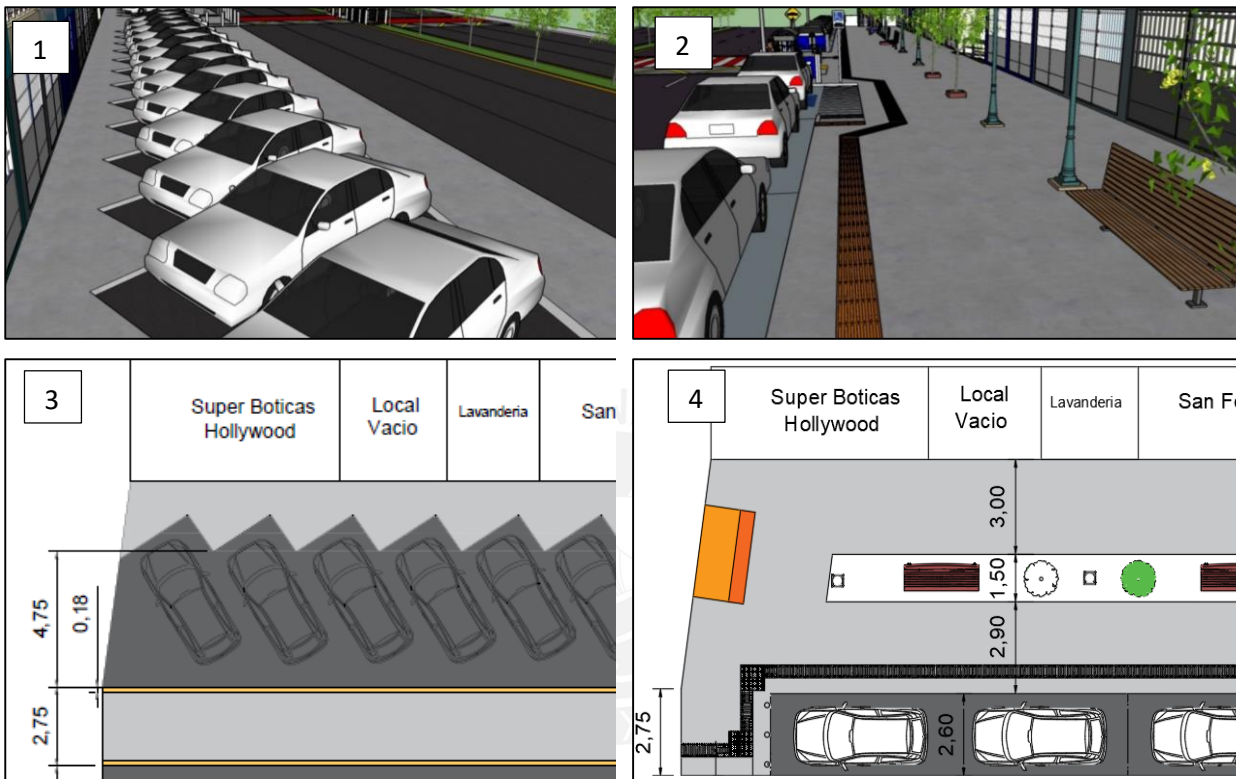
9 - Veredas : 1)Vista 3D de estado actual. 2) Vista 3D de propuesta de mejora. 3) Plano de estado actual. 4)Plano de propuesta de mejora.
